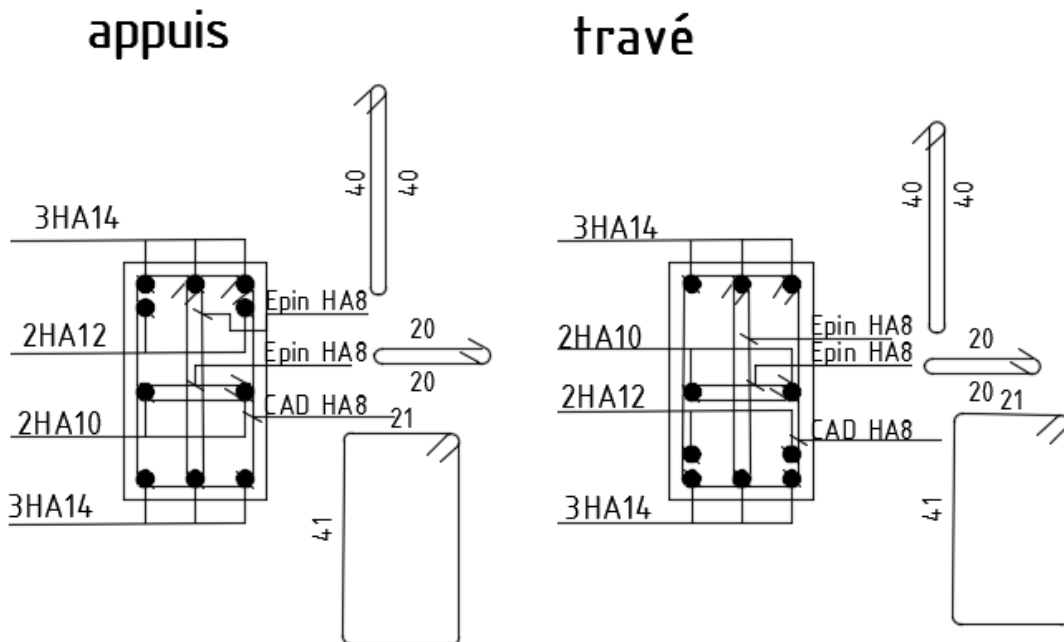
Ferraillage de la poutre principale (30x50)
